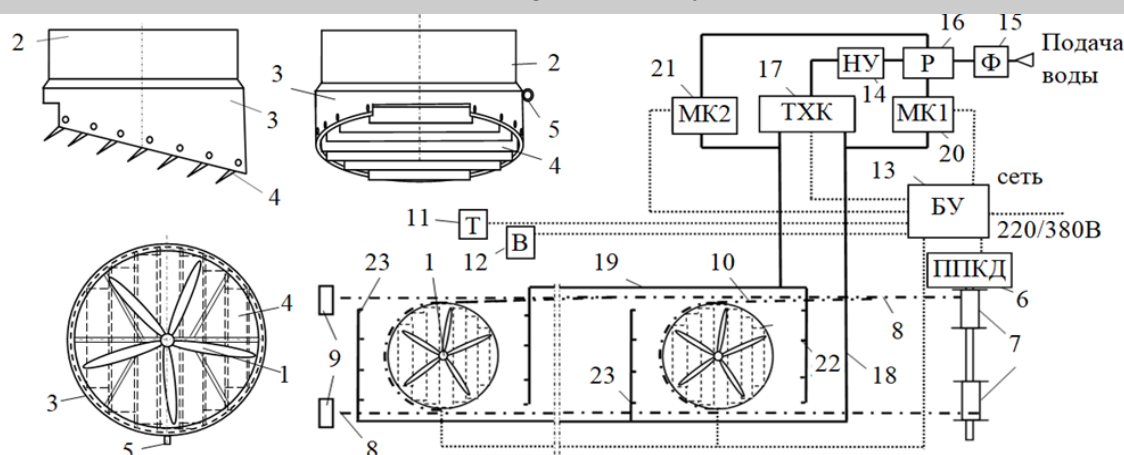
Схема устройства побуждения воздухообмена и кондиционирования для животноводческих ферм (вид сверху): 1 – осевые вентиляторы; 2 – корпус вентилятора; 3 – вращающаяся корпусная деталь; 4 – направляющие для воздушного потока; 5 – поворотное кольцо; 6 – электропривод поворота корпусных деталей с редуктором; 7 – навивочные барабаны; 8 – магистральные тросы; 9 – противовесы; 10 – соединительные тросы; 11 – датчик температуры; 12 – датчик влажности; 13 – блок управления; 14 – насосная установка; 15 – фильтр для очистки воды; 16 – резервуар для воды; 17 – трехходовой электромагнитный клапан; 18, 19 – ветки водопровода высокого давления; 20, 21 – запорные электромагнитные клапана; 22, 23 – группы распылительных форсунок, подсоединенные к веткам водопровода 19 и 18 соответственно.
